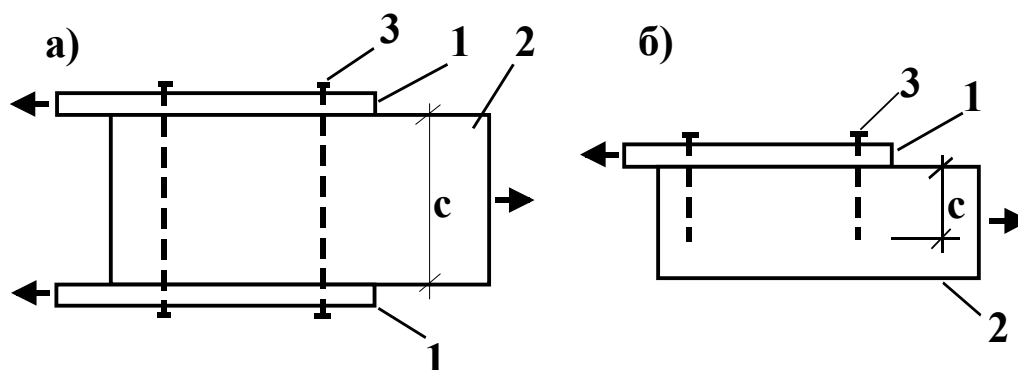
Симметричное (а) и несимметричное (б) нагельное соединение со стальными накладками
